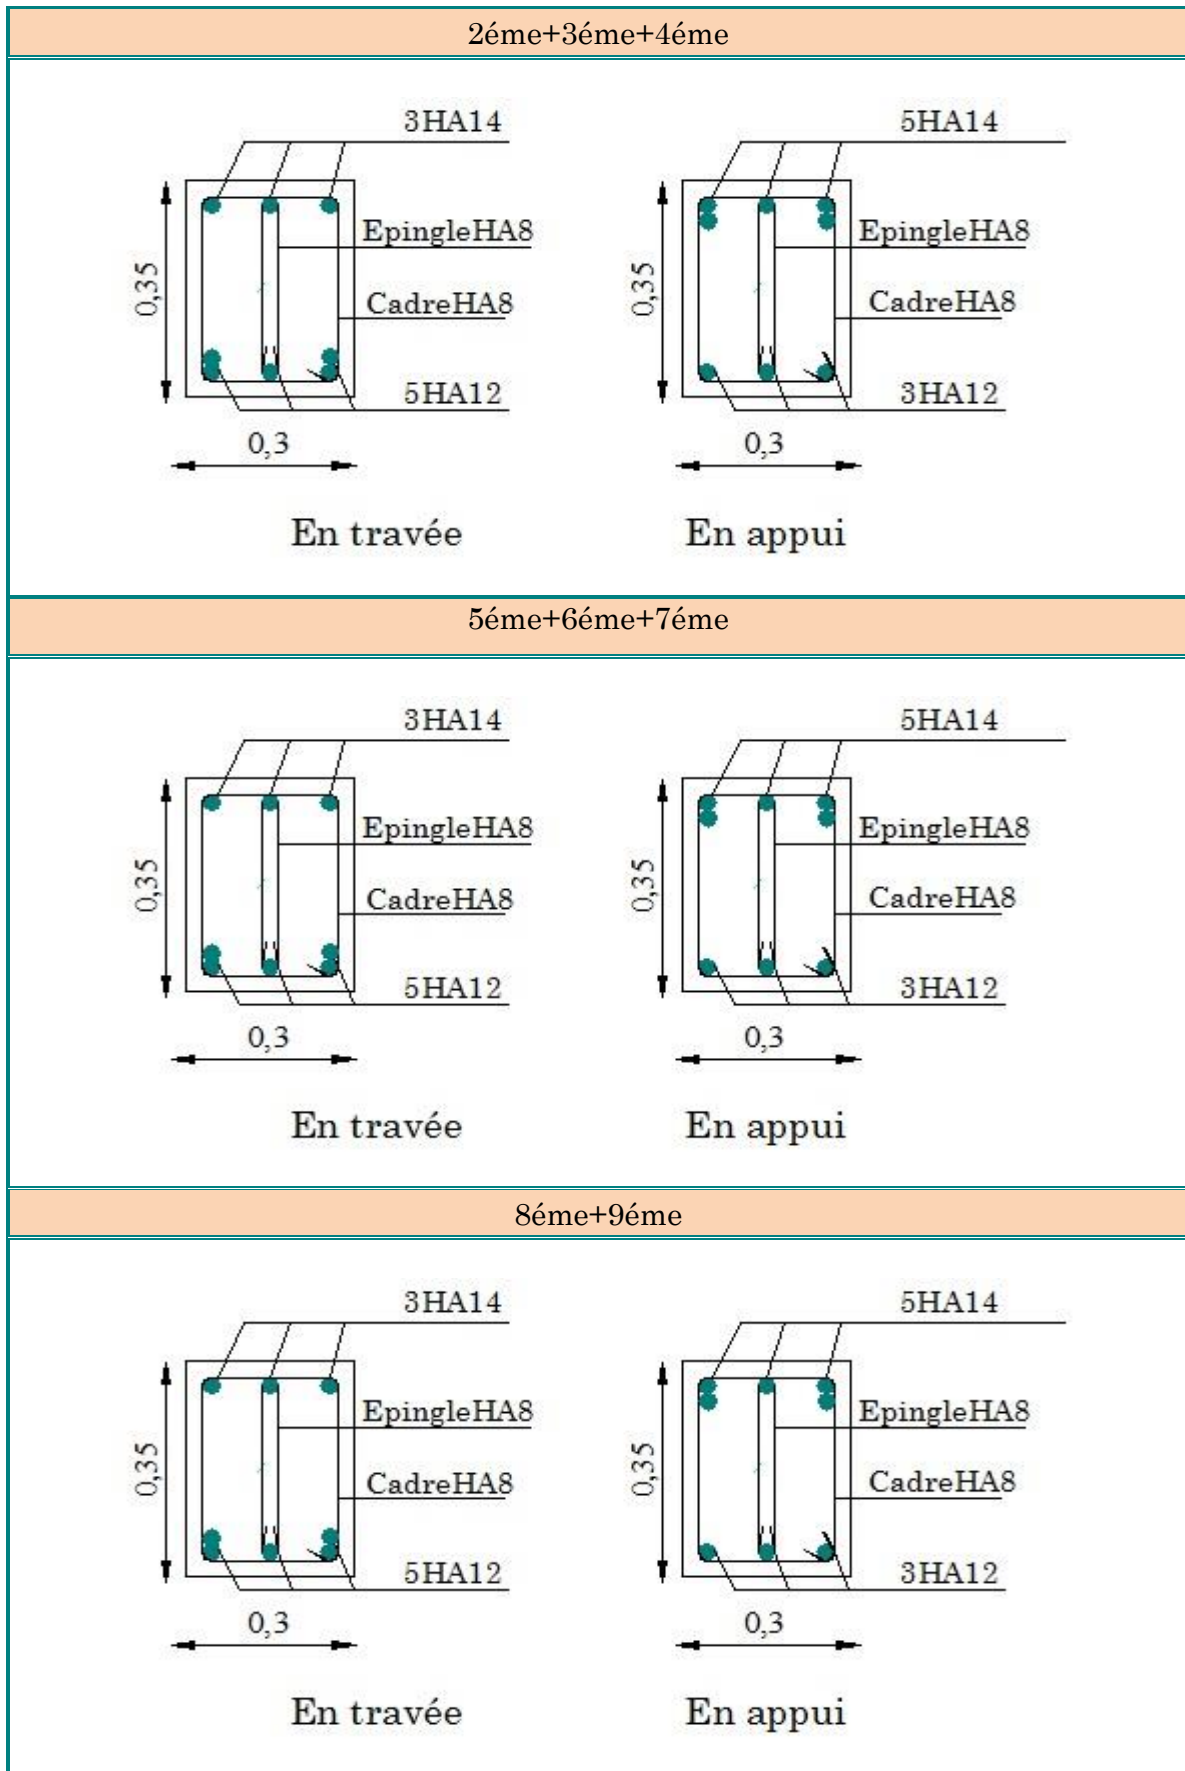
Schéma de ferrailage des poutres secondaires.
